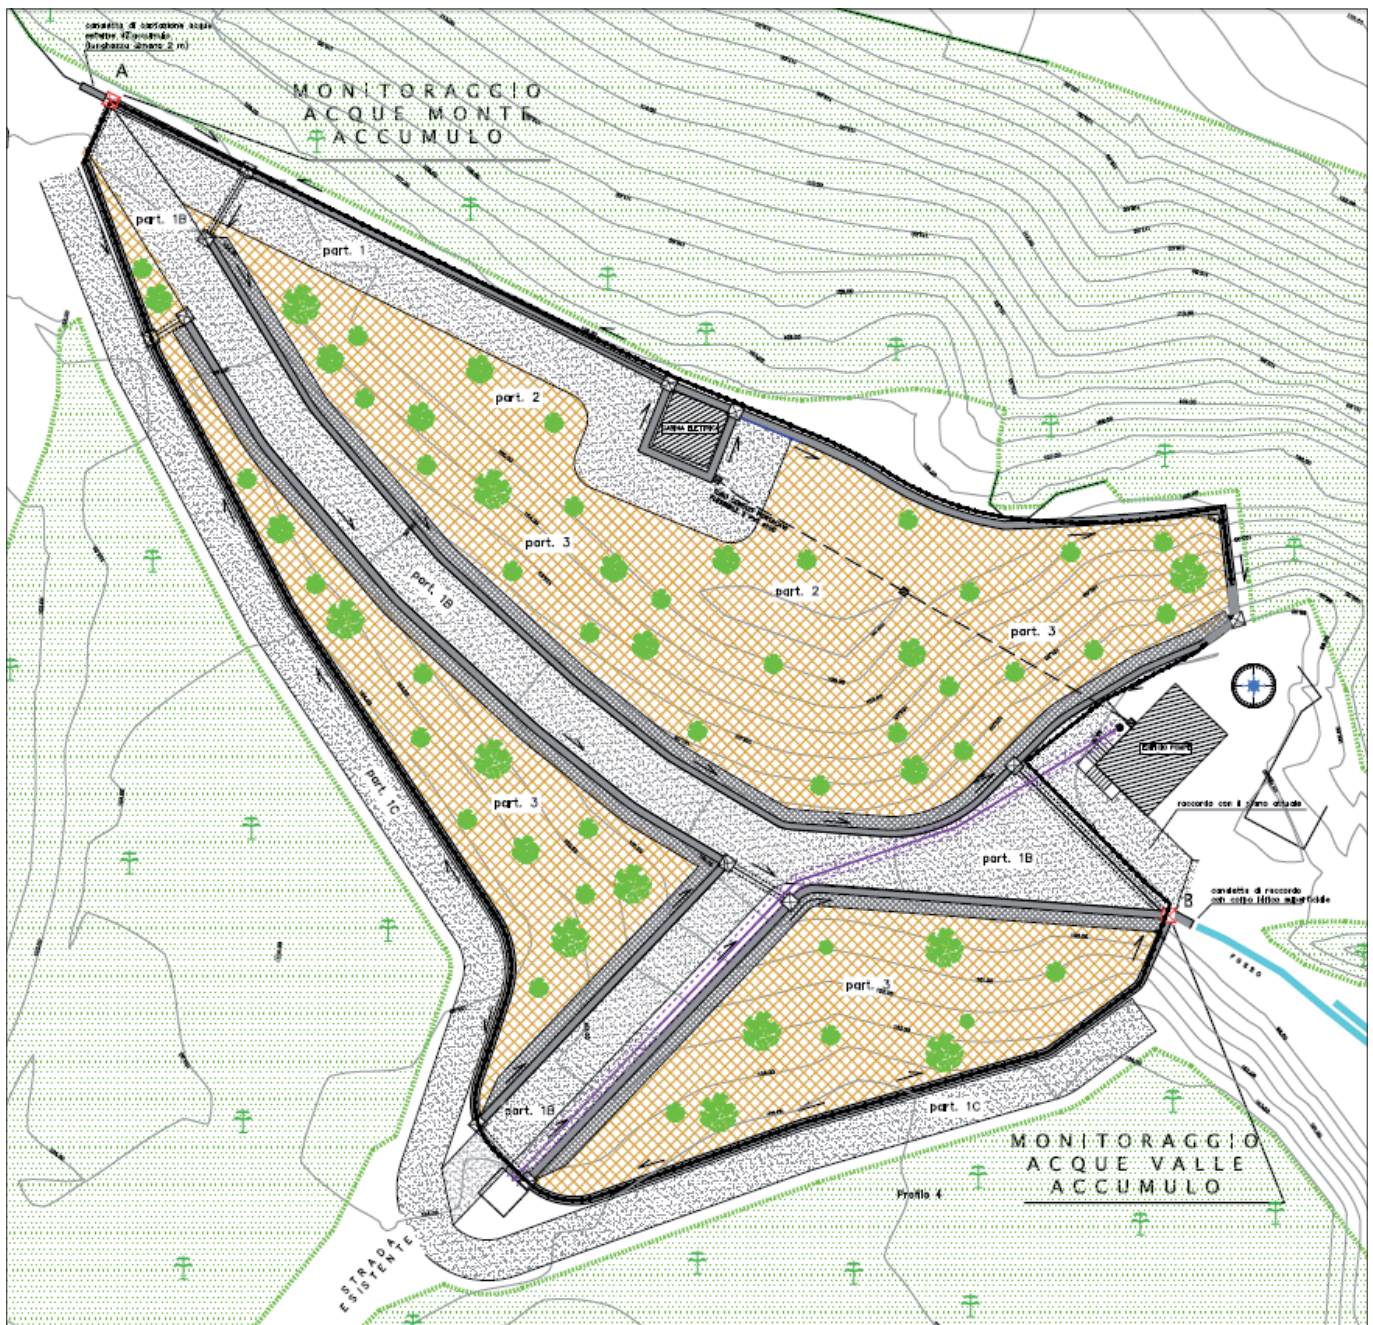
Planimetria rete drenaggio e stato finale di progetto dell'accumulo con punti di campionamento acque superficiali. A dx, in azzurro, il tracciato del fossetto di scolo che convoglia le acque meteoriche verso il F. Bruna
